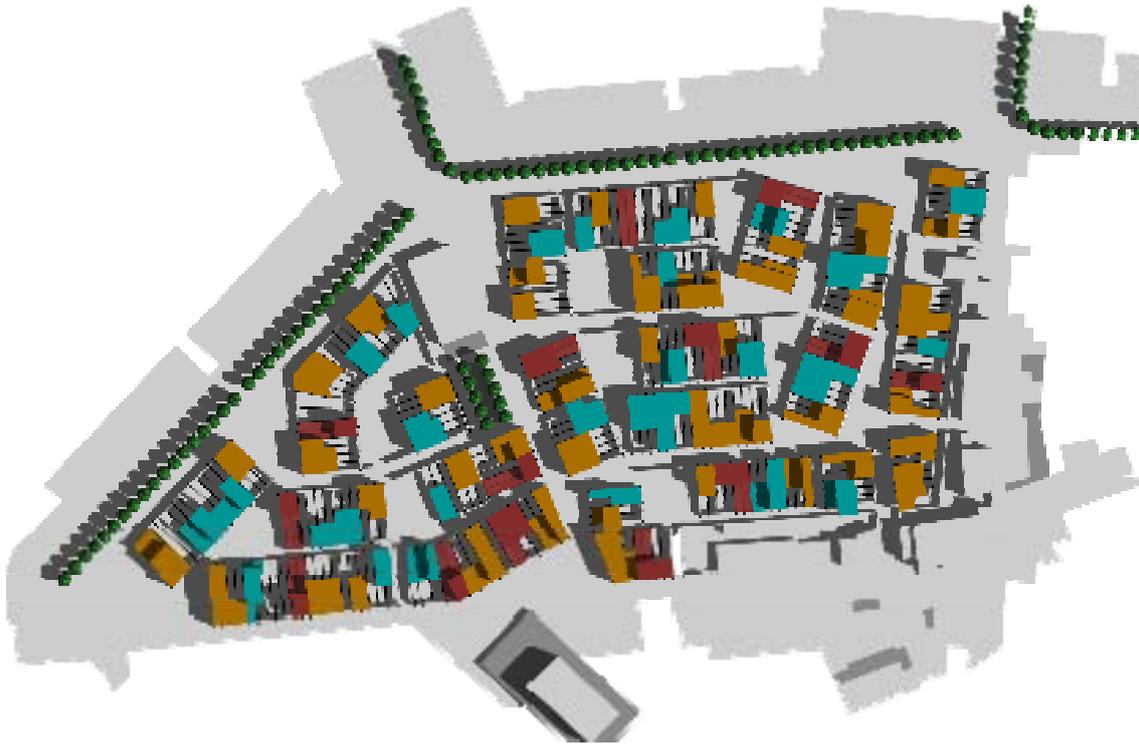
Plano do grupo 2 – Planta da solução proposta.
